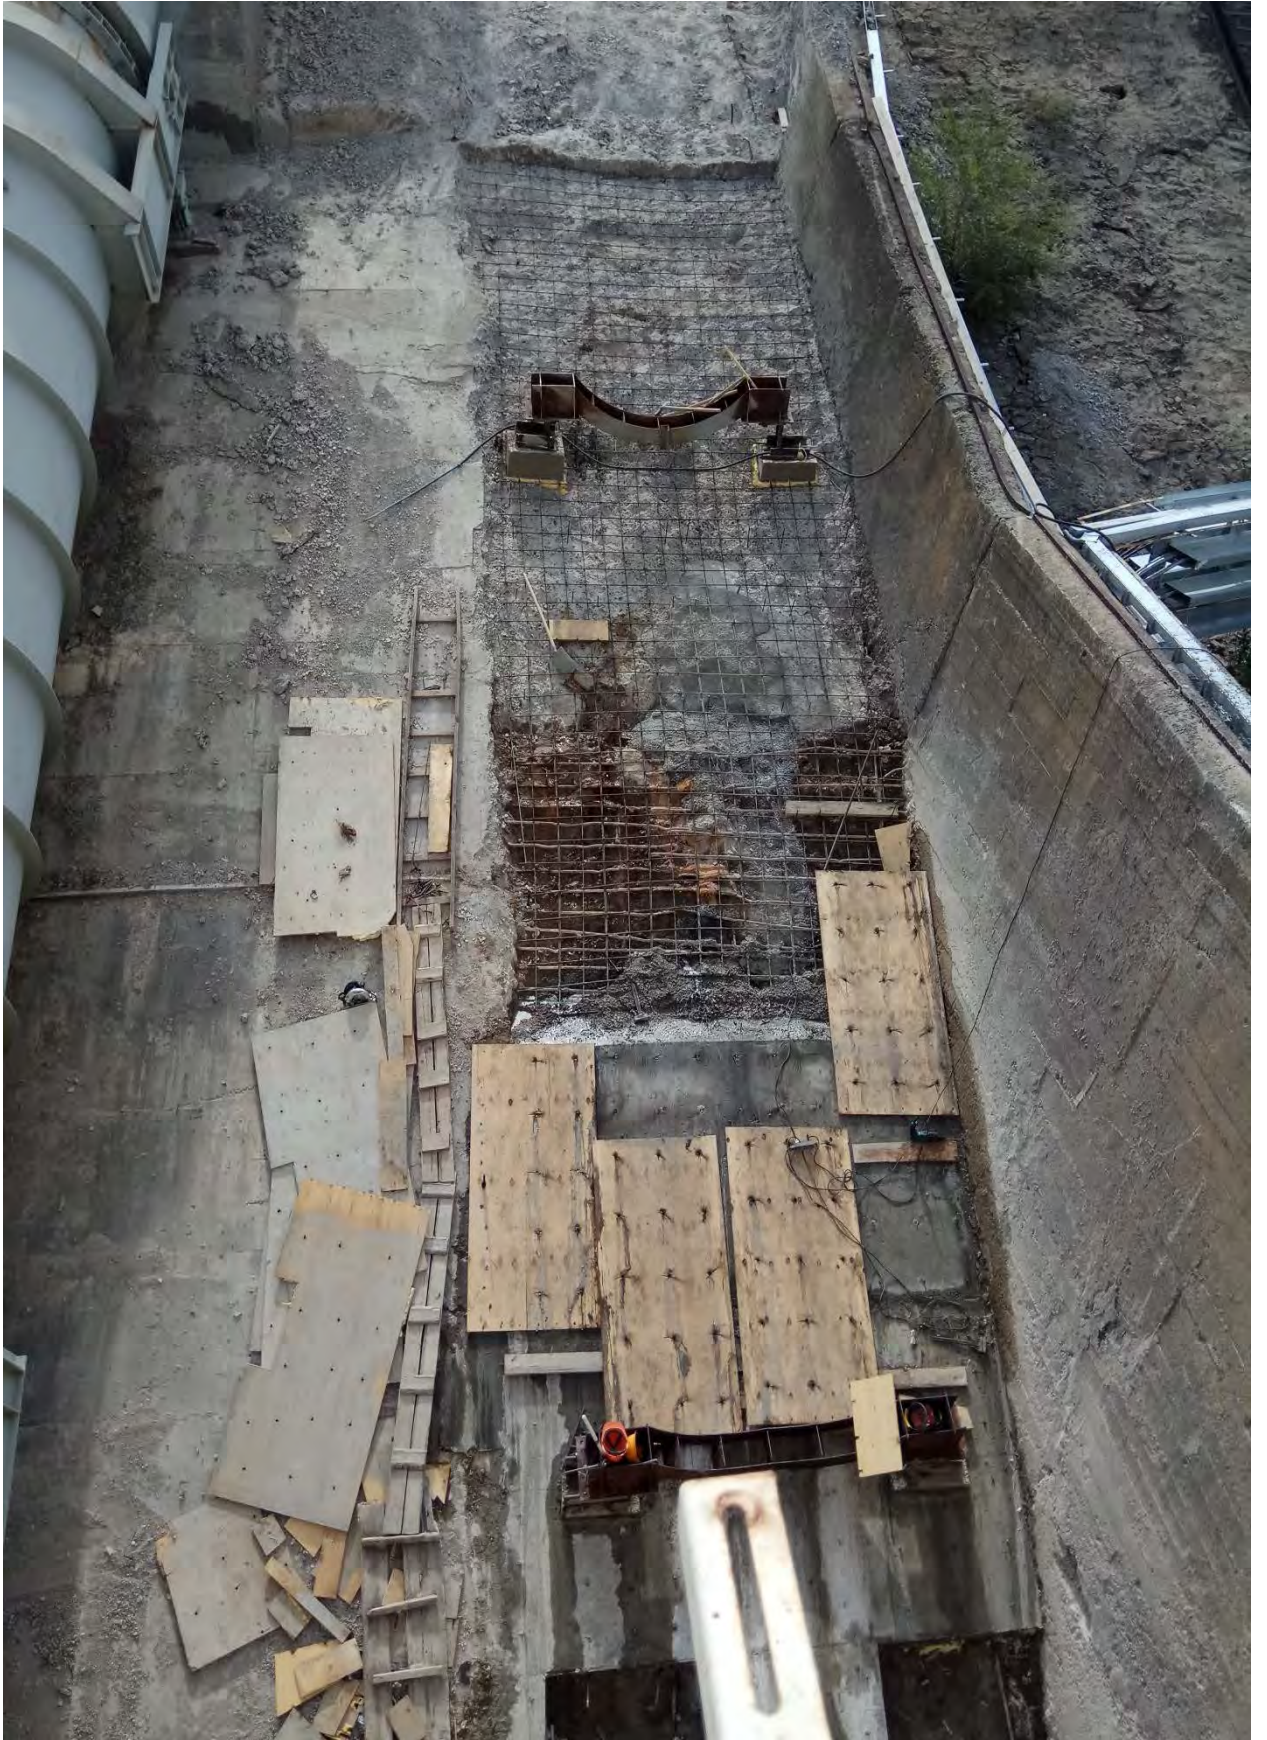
,23. Армирование и бетонирование основания для нитки №3 трубопровода в доковой части насосной станции.
